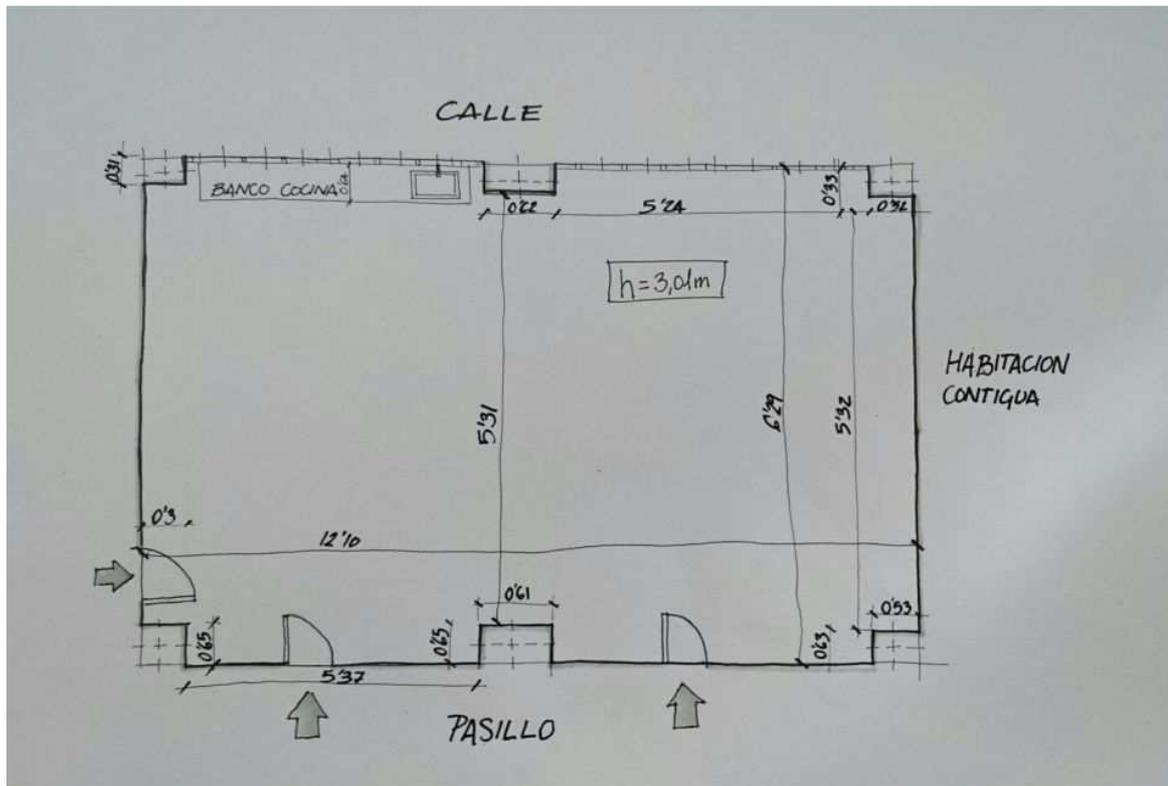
Entrega del trabajo práctico sobre levantamiento de plano por los estudiantes.
